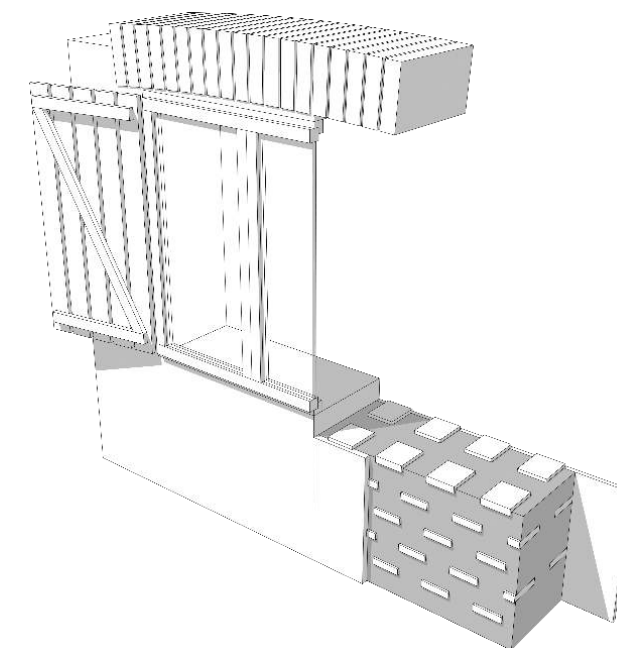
Detalle Constructivo Muro. Autor Propio. 2015
